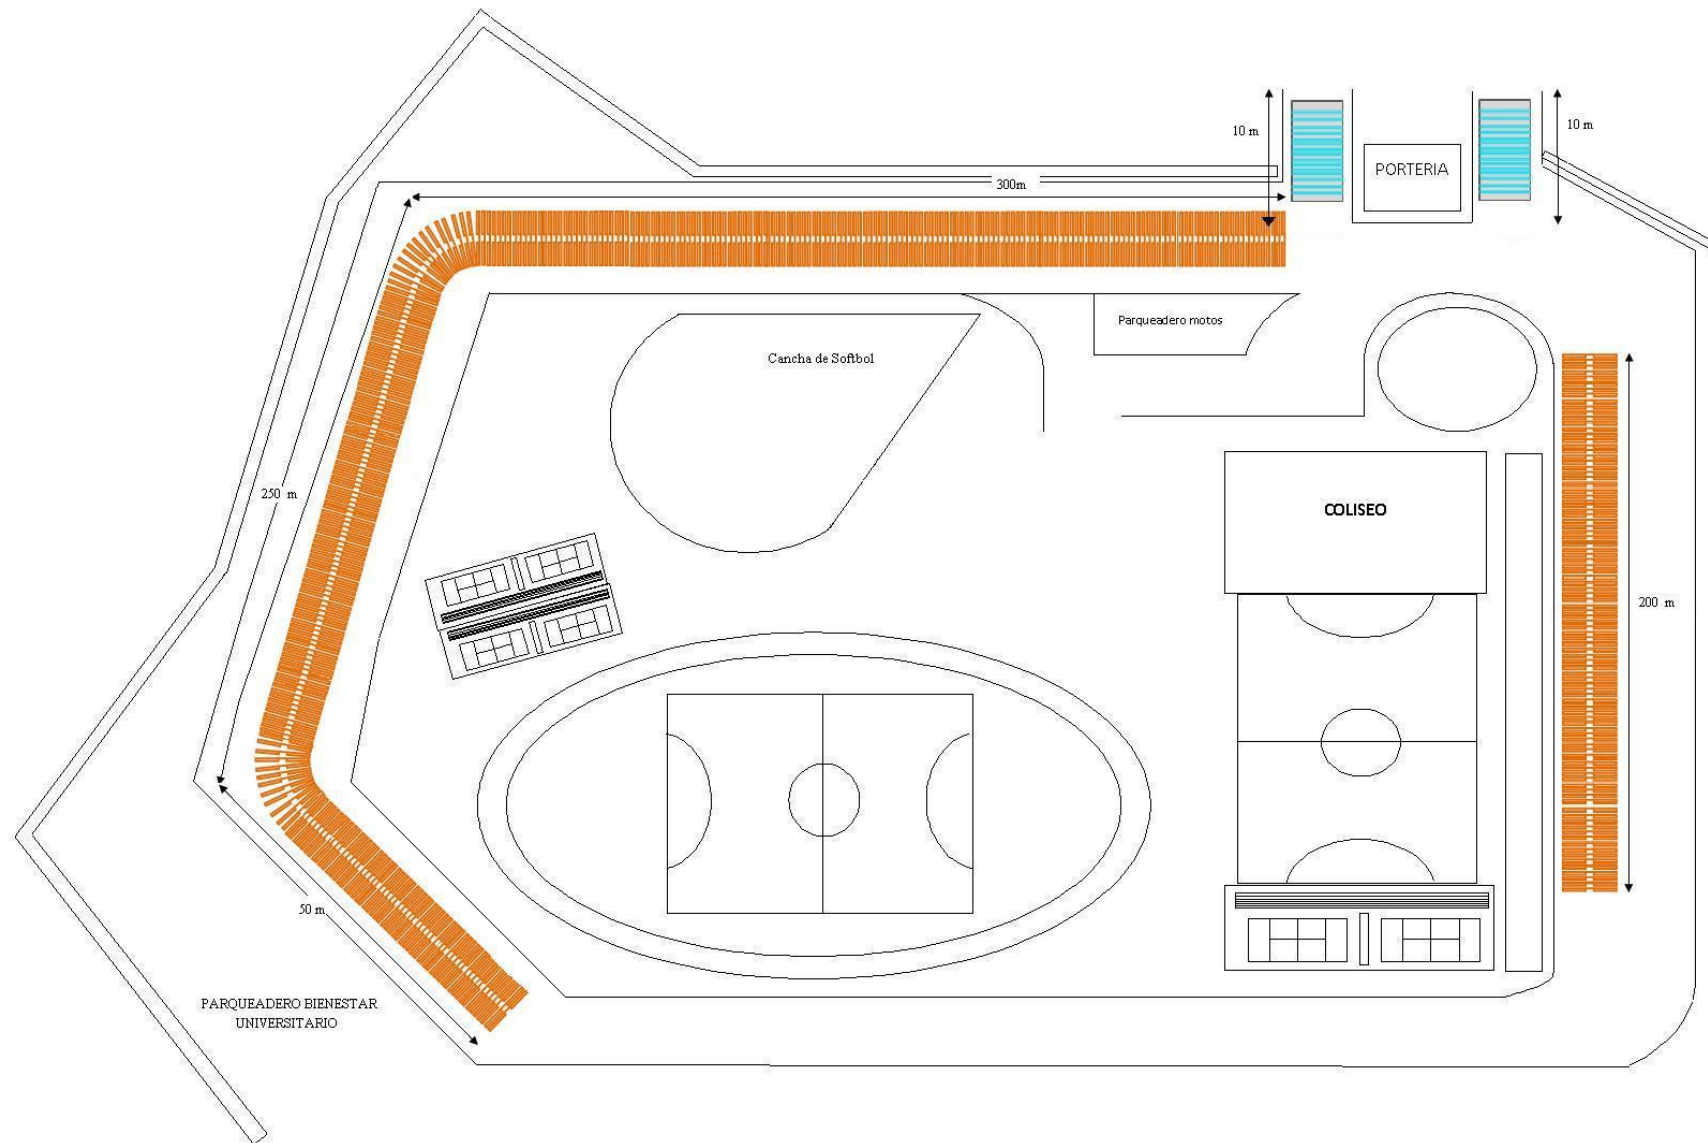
Entrada carrera 30 teniendo instalados los dispositivos de Electro Kinetic Road Rampe Innowatech.
